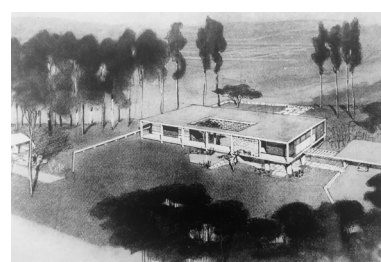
Croqui da volumetria e implantação da residência no terreno.
